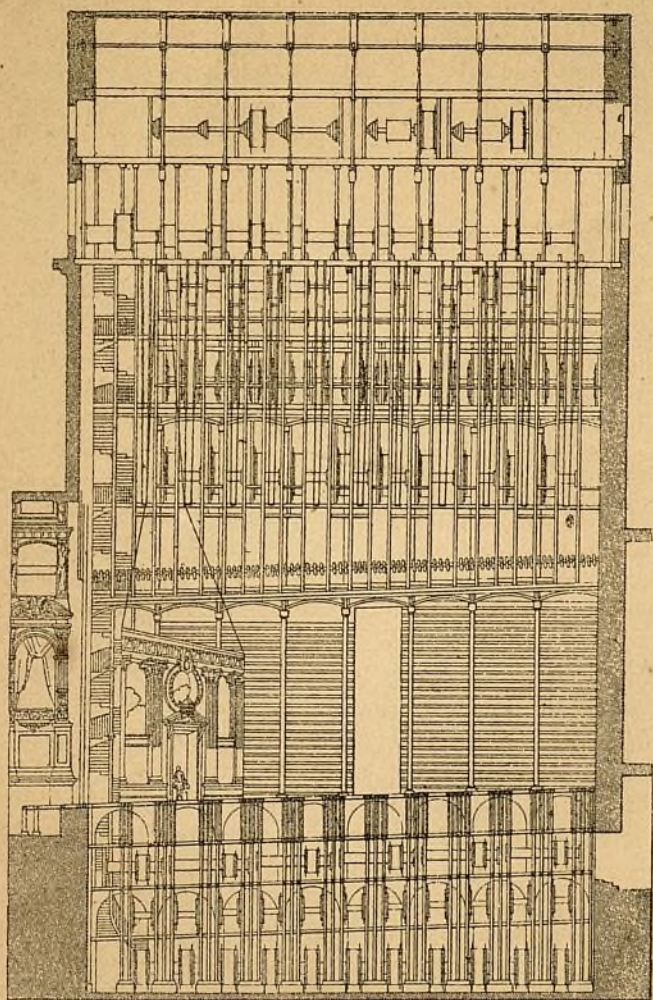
Corte longitudinal de un teatro.—Armadura del techo
